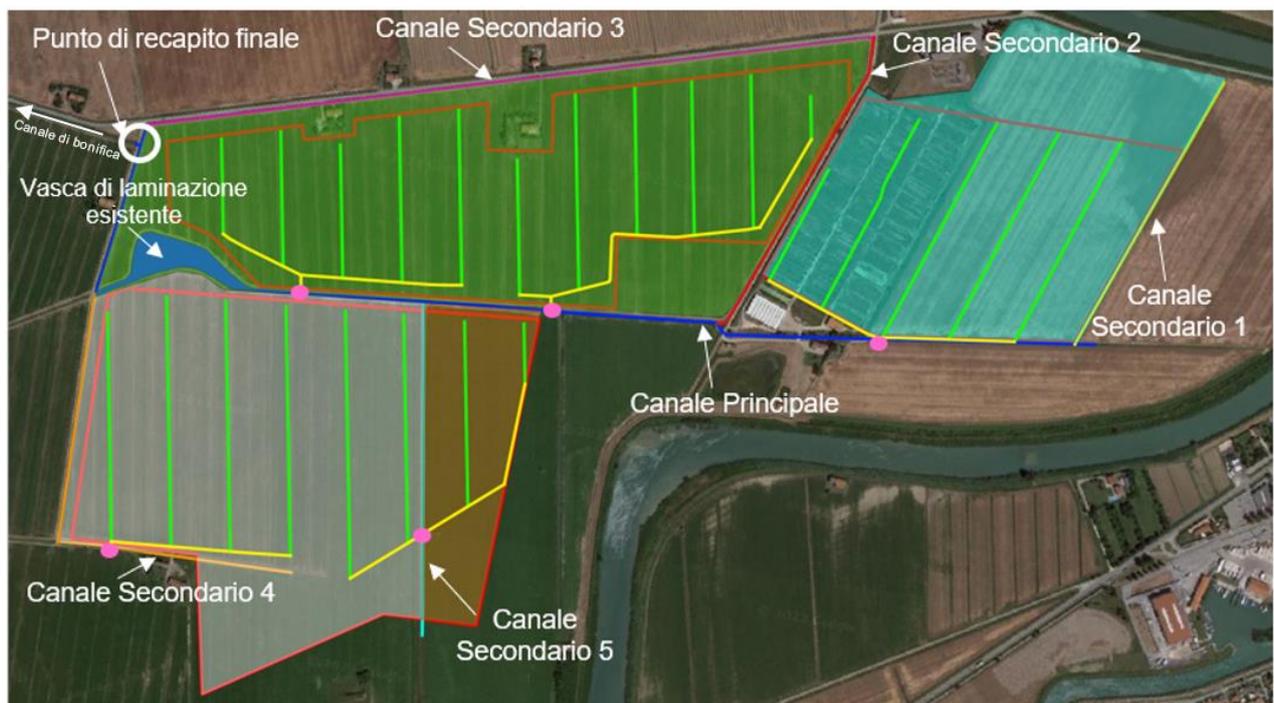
Schematizzazione del sistema di drenaggio dell'area di impianto in progetto
